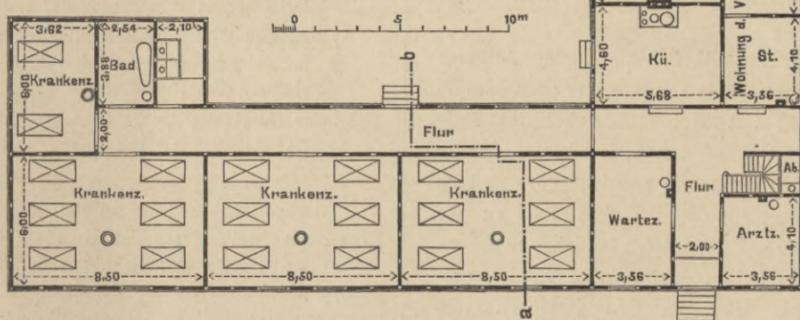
Lazarethanlage bei Burg. Erdgeschoss.
